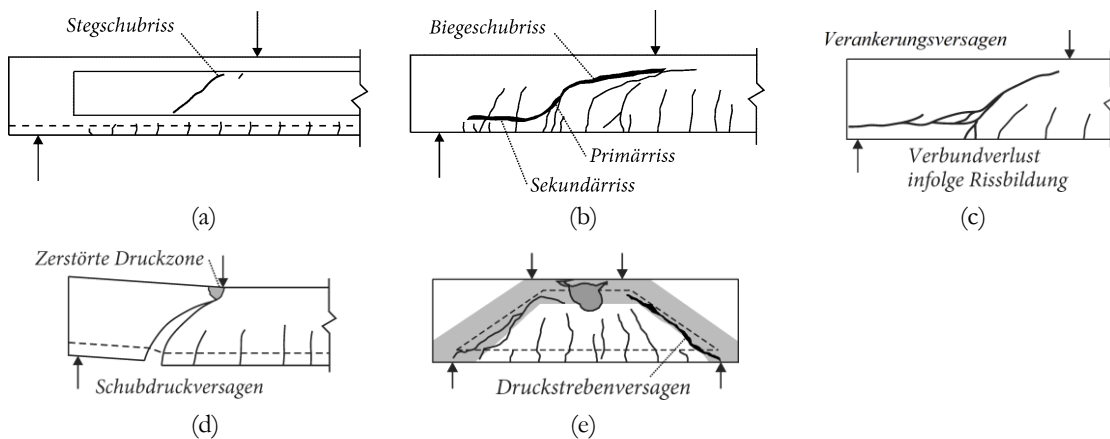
Versagensarten bei Balken ohne Querkraftbewehrung: (a) Stegschubversagen, (b) Biegeschubversagen, (c) Verankerungsversagen, (d) Schubdruckversagen, (e) Druckstrebenversagen, entnommen und modifiziert aus [60]
